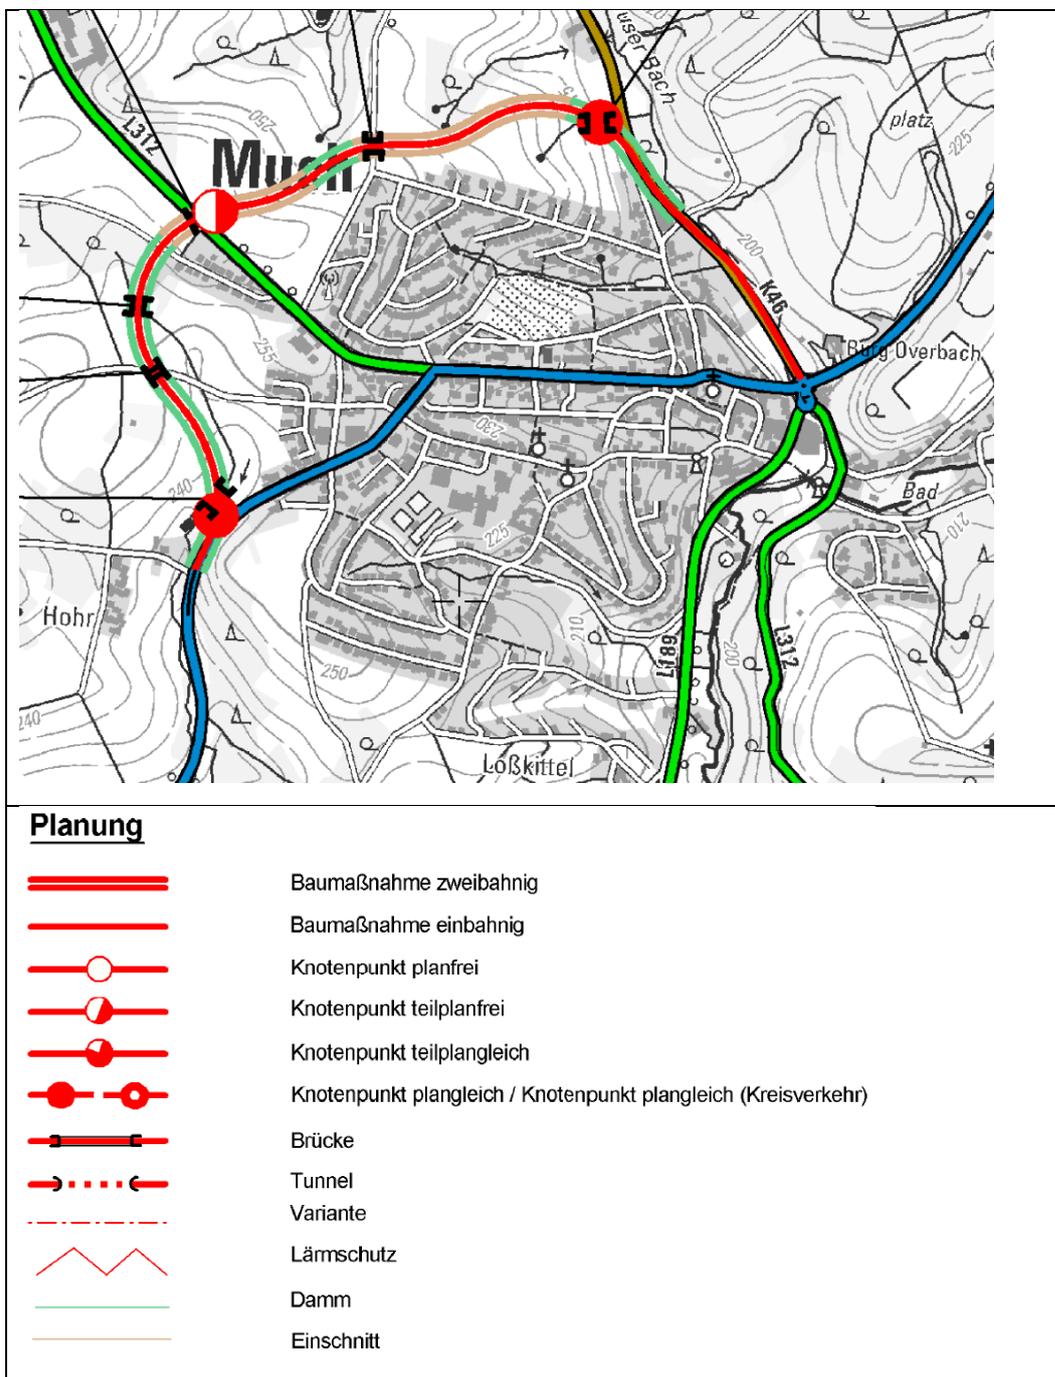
Ausschnitt Übersichtslegeplan OU Much Nord, Quelle: Straßen NRW, 2013
